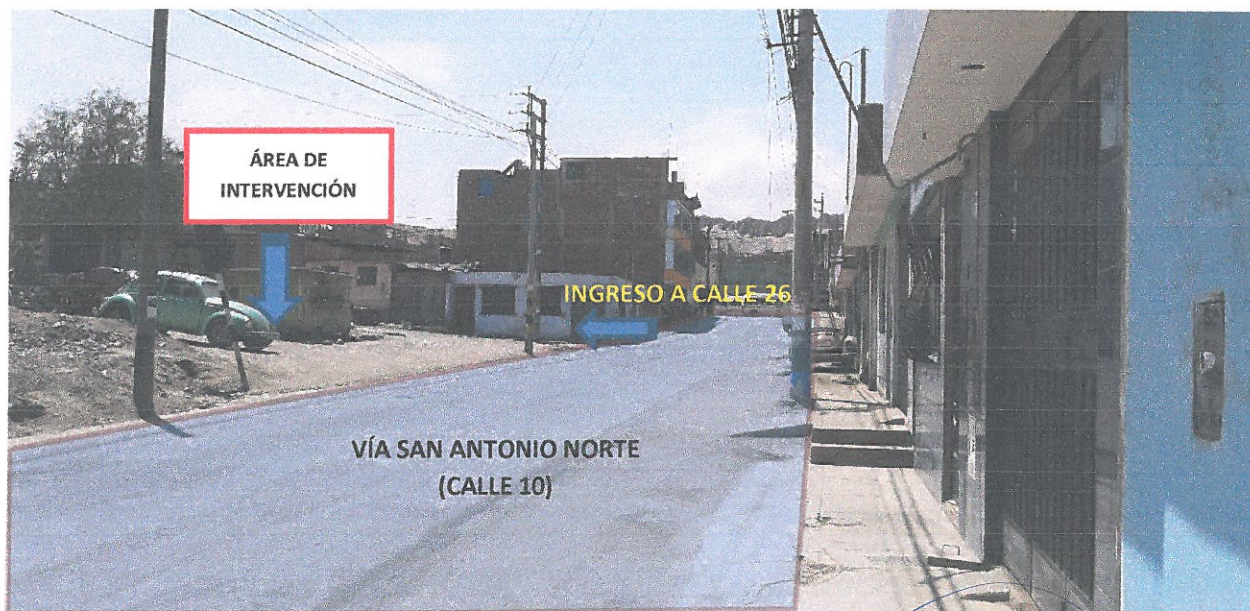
Vista de la Calle 10 prolongación de la Av. San Antonio Norte (vía colectora).
